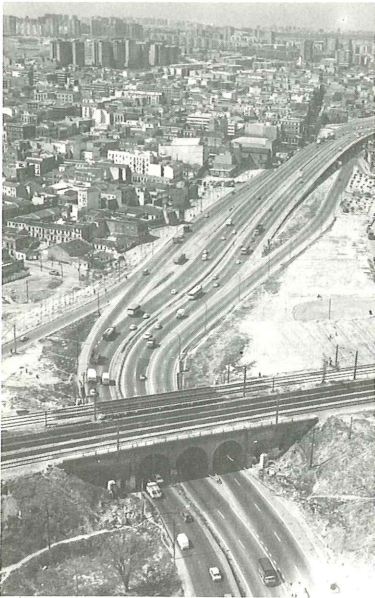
Puente de los Tres Ojos. Vista superior: 6 vfas. Ladrillo + metálico.
